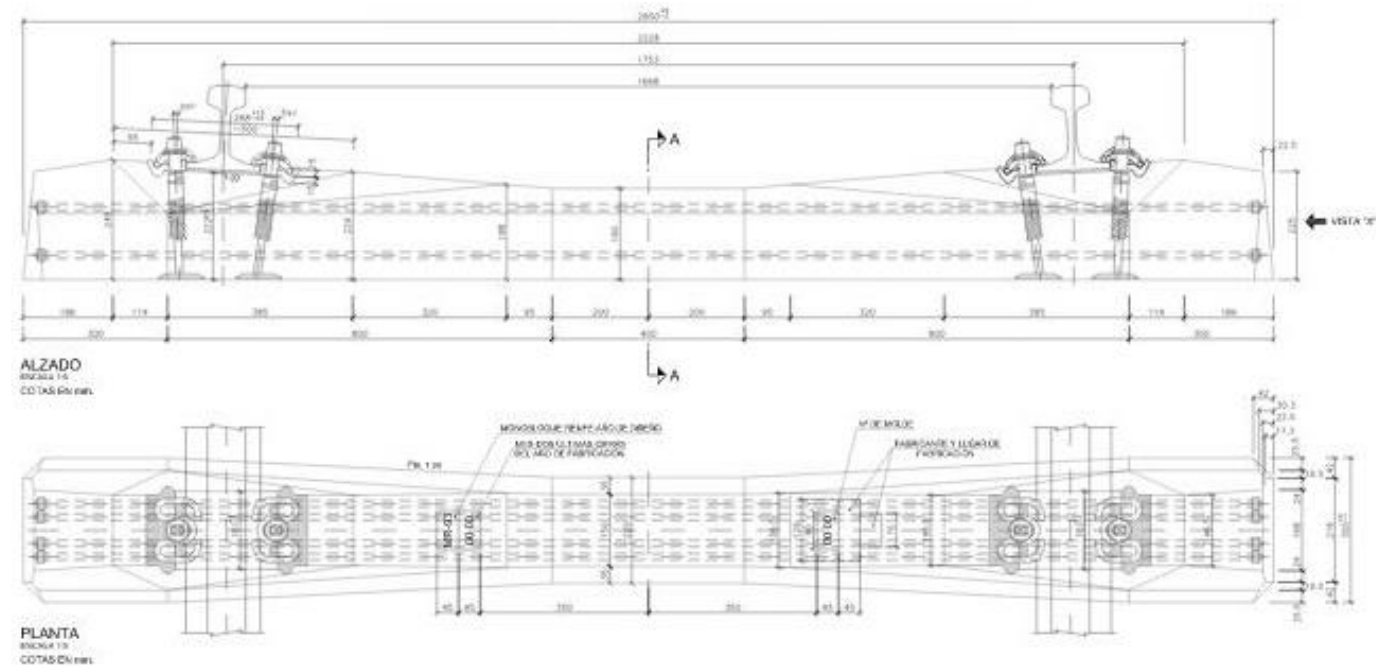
Traviesa Monobloque Monovalente tipo MR-93
